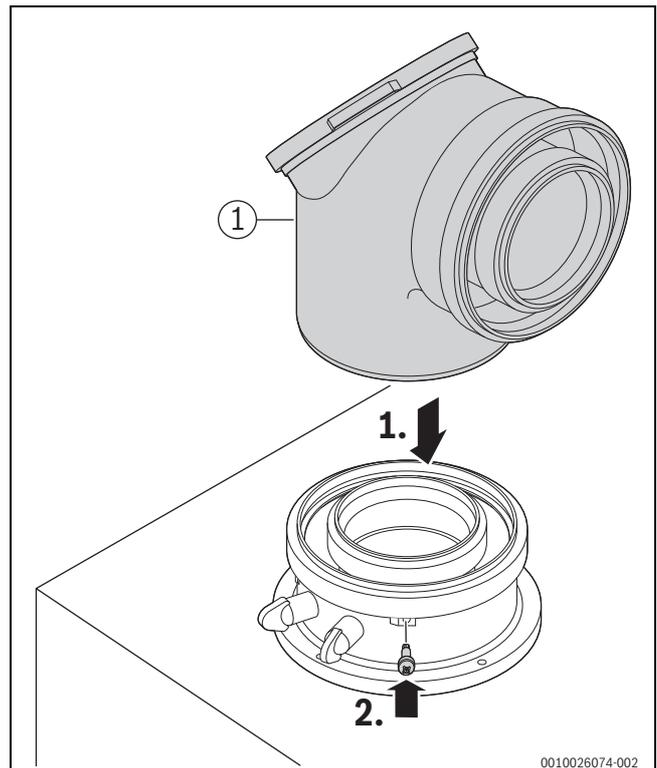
Abgaszubehör einsetzen und mit Schraube sichern
